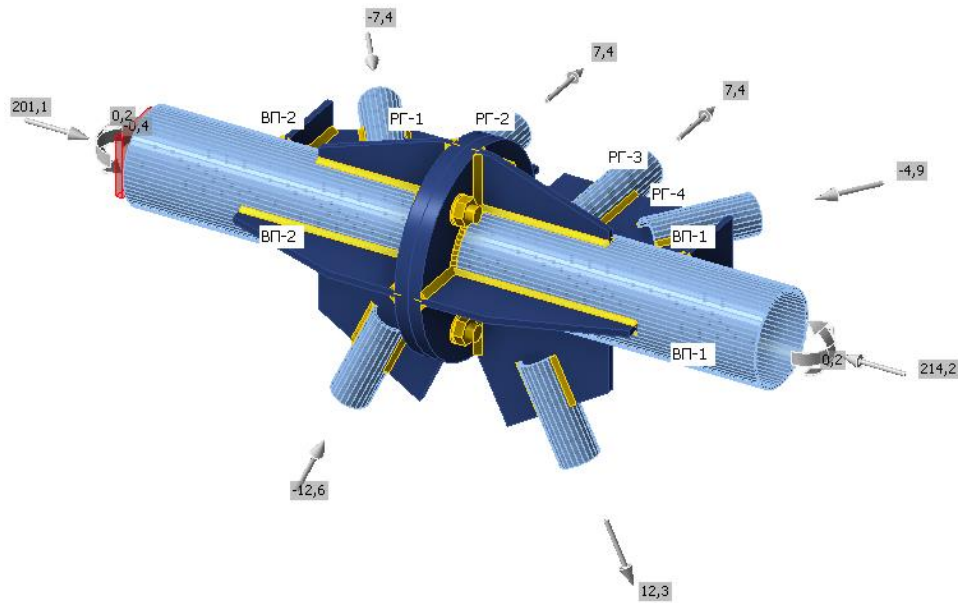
Монтажный стык верхнего поясу просторового блока фермы
